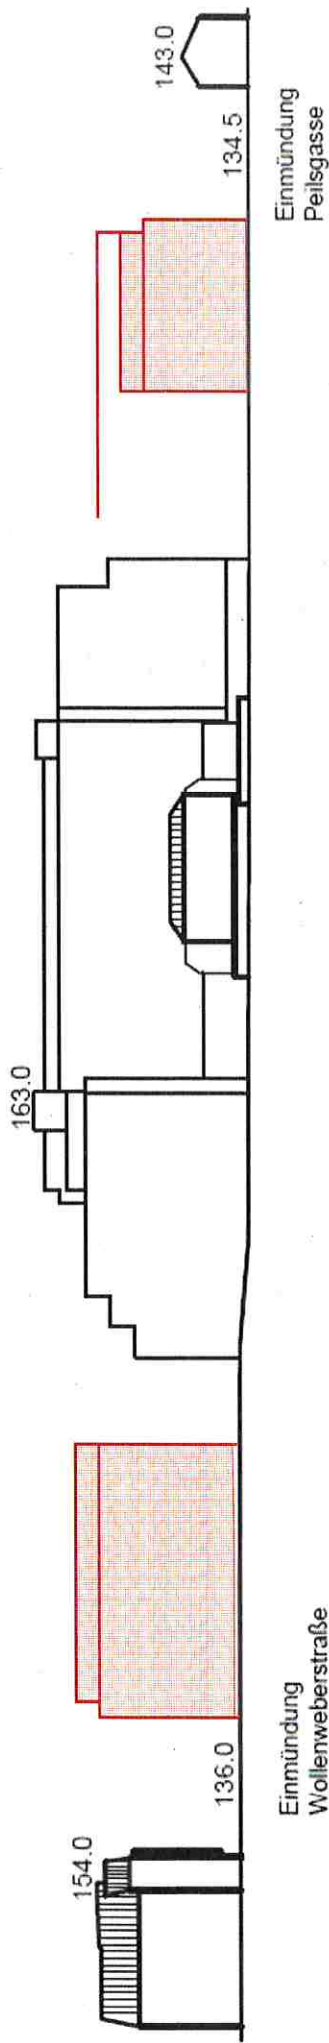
Schematische Fassadenabwicklung Indestraße, Höhenangaben näherungsweise in m ü NHN [Quelle: Stadt Eschweiler]
